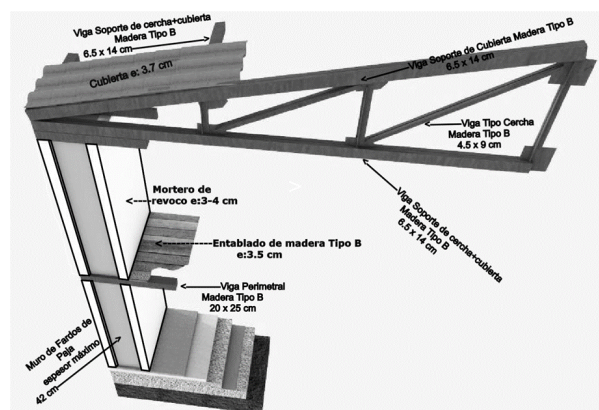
Muro de fardo de paja, sección vista tipo sánduche
